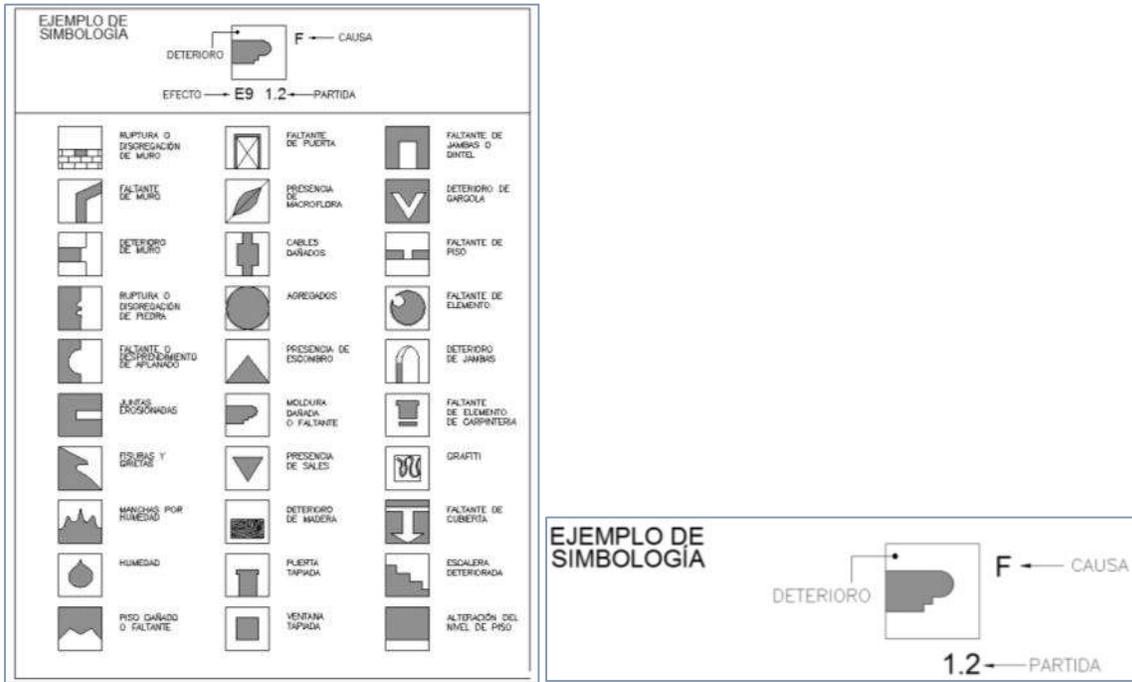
Simbología utilizada en la planimetría del levantamiento de alteraciones y deterioros. Elaborada por Aldo Zamudio Pérez
